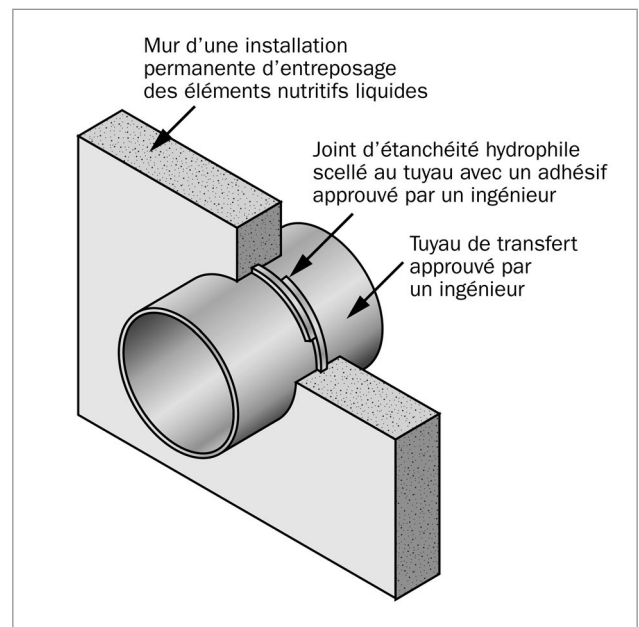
Joint d'étanchéité hydrophile : croquis d'une ouverture dans un mur.
